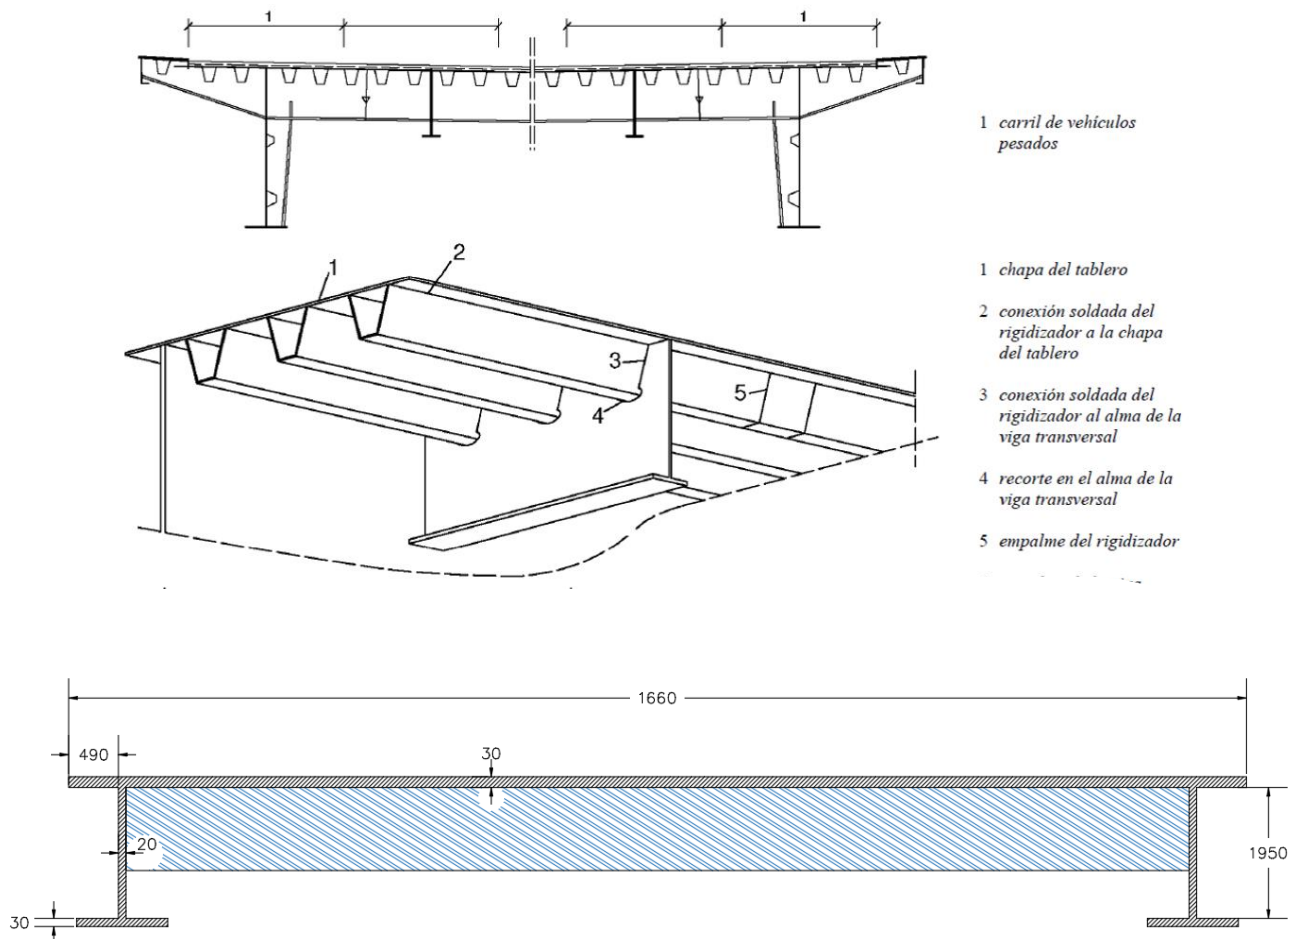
Geometría tablero viga bijácena
